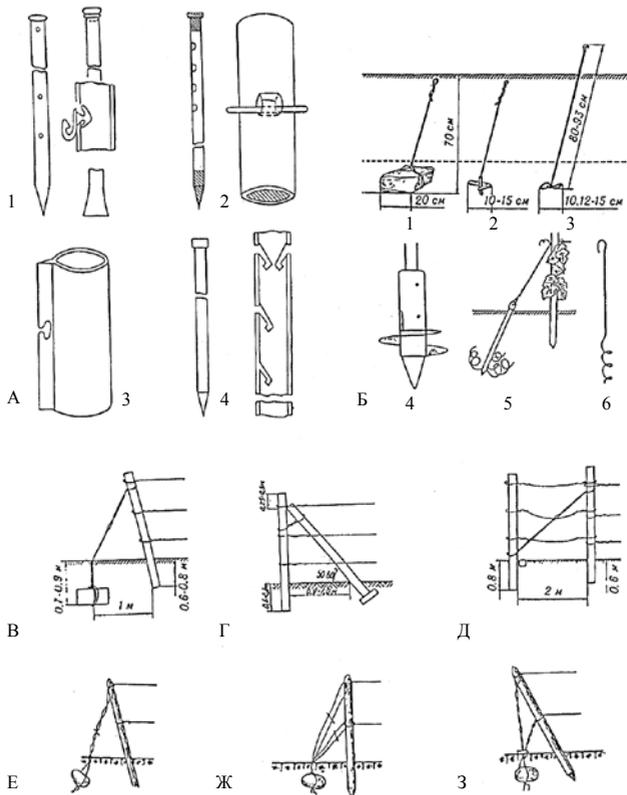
Виды стоек и якорей с разными способами их крепления и установки: А. Стойки пластиковые: 1 – цилиндрические с устройством проволок в виде крючков; 2 – трубчатые с устройством проволок в виде пазов и ушек; 3 – цилиндрические с ребром жесткости; 4 – трубчатые с углублениями для крепления проволоки; Б. Виды якорей для крепления крайних столбов: 1 – бутовый камень; 2 – винтовой якорь с четырехгранным стержнем; 3 – дисковый якорь на штанге с петлей; 4 – пластмассовый якорь с одним ходом резьбы; 5 – якорное устройство пружинного типа; 6 – металлический якорь винтового типа или пропеллерного типа; В, Г, Д, Е, Ж, З. Способы крепления якорных столбов: В – якорем; Г – упором; В – якорной стойкой; Е, Ж – якорное косое; З – якорное вертикальное.
